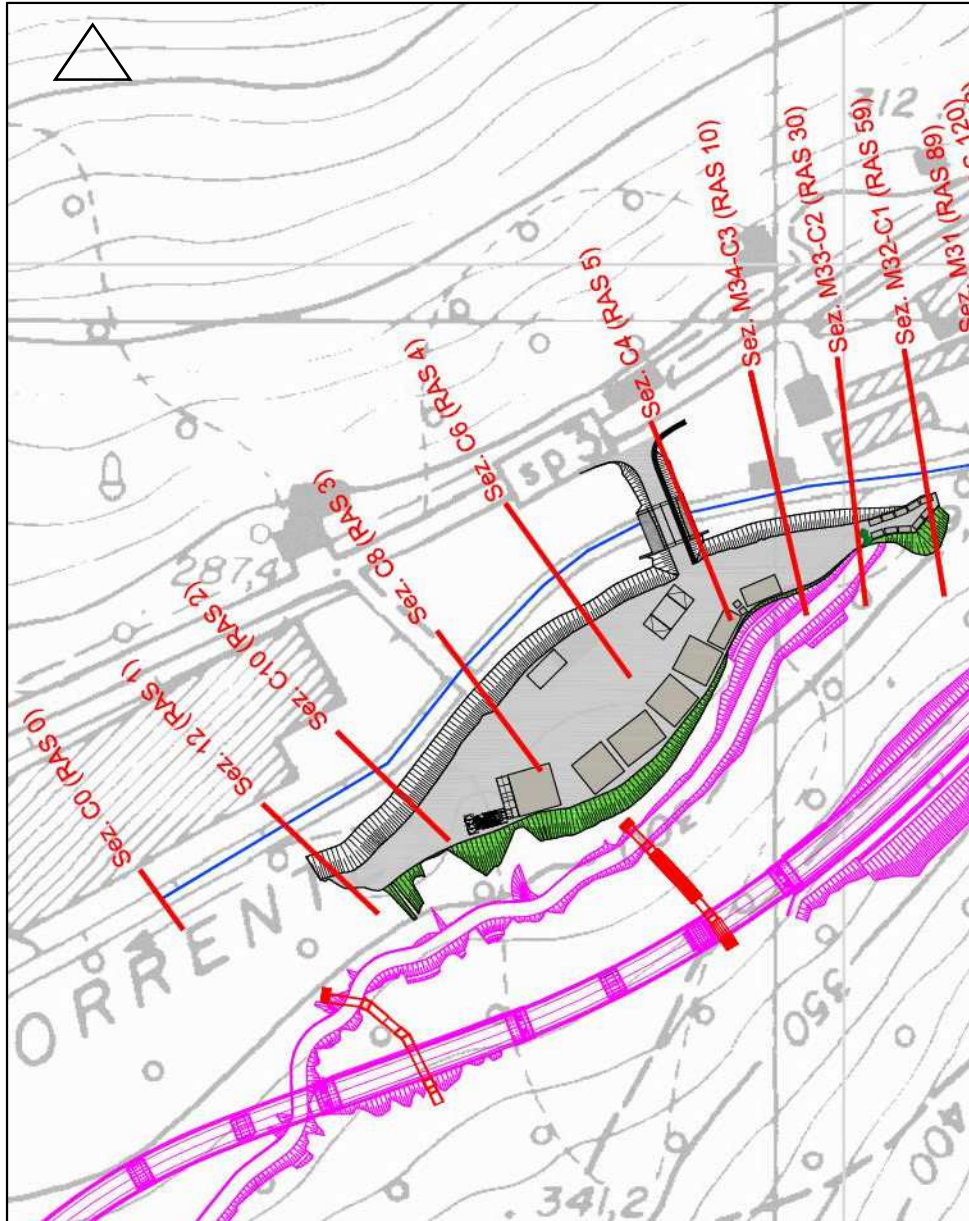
Torrente Faidana - Planimetria tratto Cantiere e indicazione sezioni RAS
